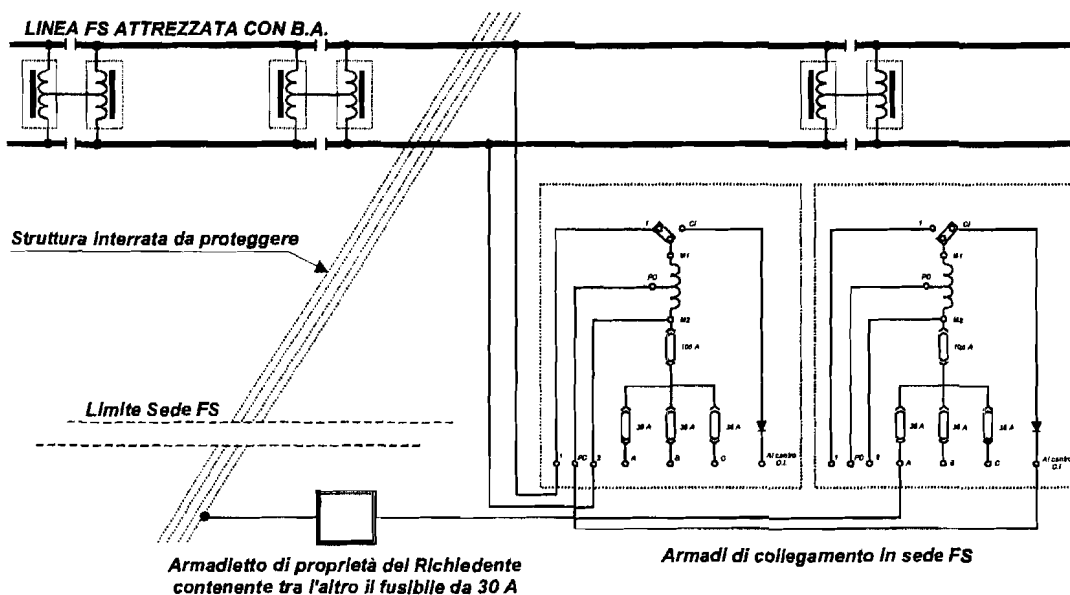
Impianto di drenaggio su linee attrezzate con BA con collegamento al binario
